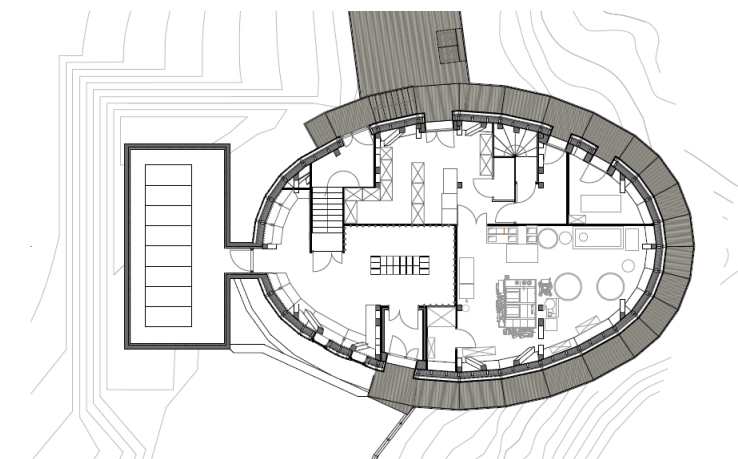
Pianta piano seminterrato del rifugio Gouter
